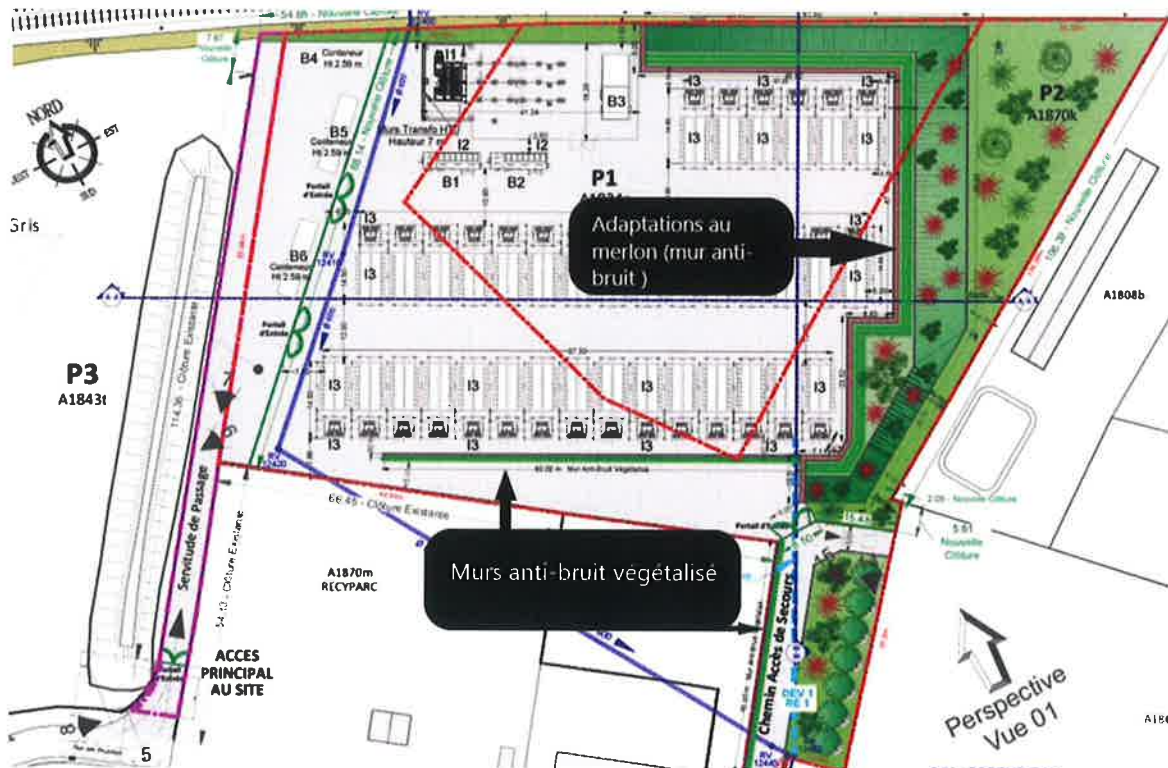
Détail du plan d'implantation version dossier plans modificatifs (15/7/2024)
